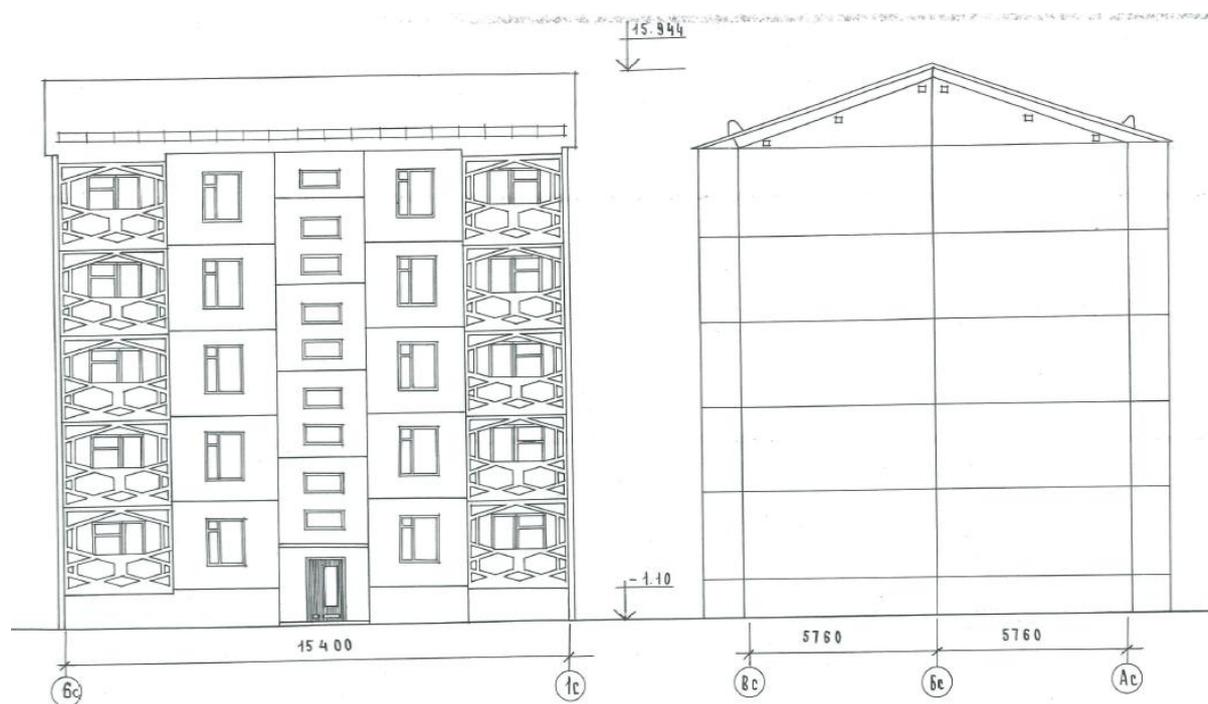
Schnitt und Ansicht Gebäudetyp 1KZ, Baujahr 1985
